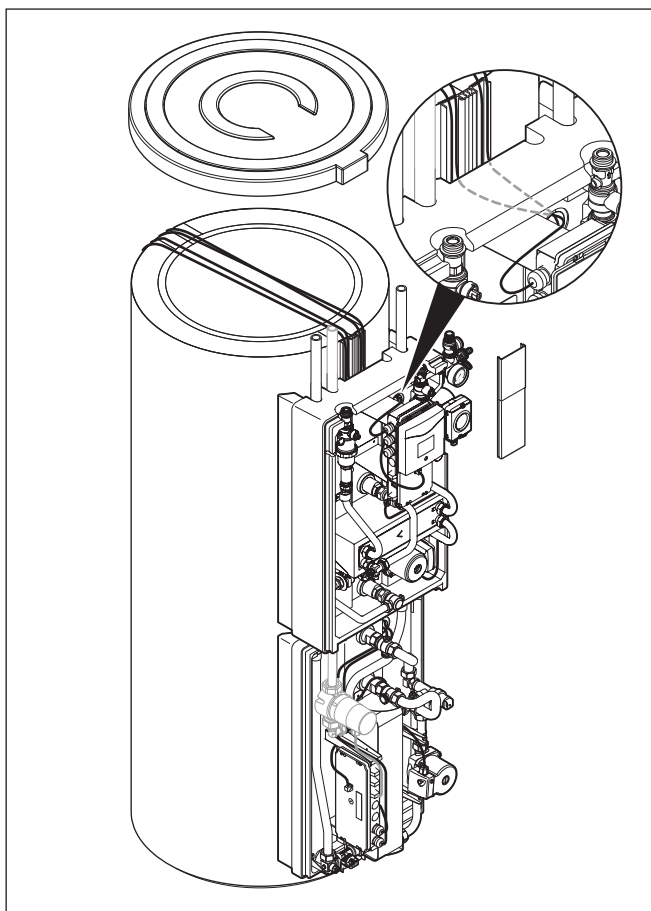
Posa dei cavi elettrici nella canalina del bollitore tampone VPS/2, in un impianto con stazione di carica solare
